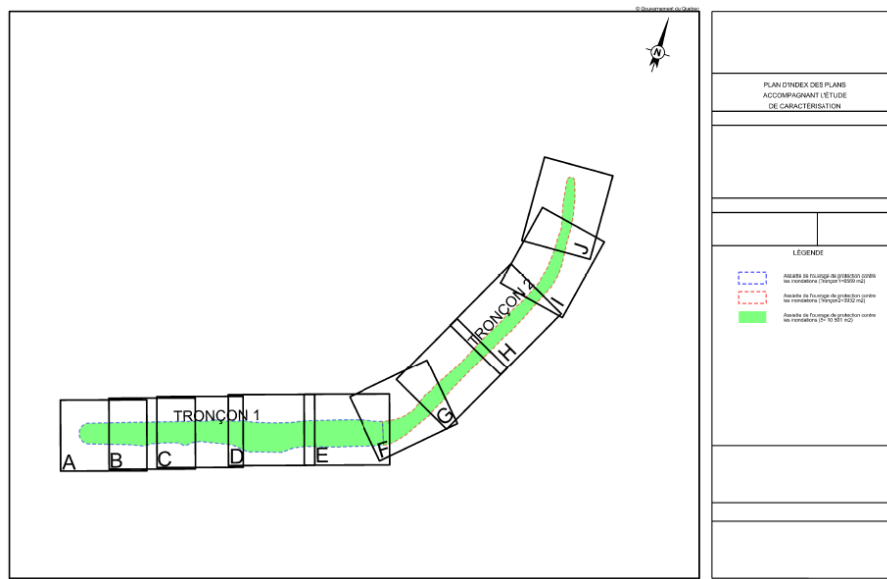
Exemple d'un plan d'ensemble d'un OPI.
